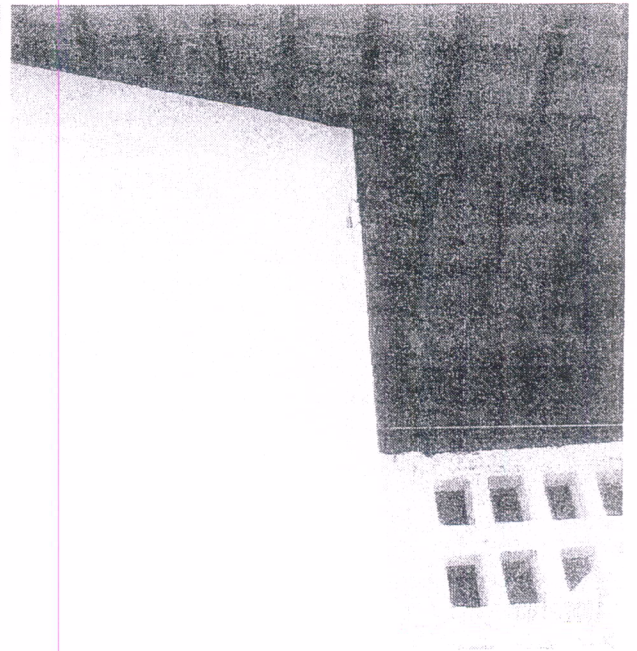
Fissuras verticais junto aos pilares de
